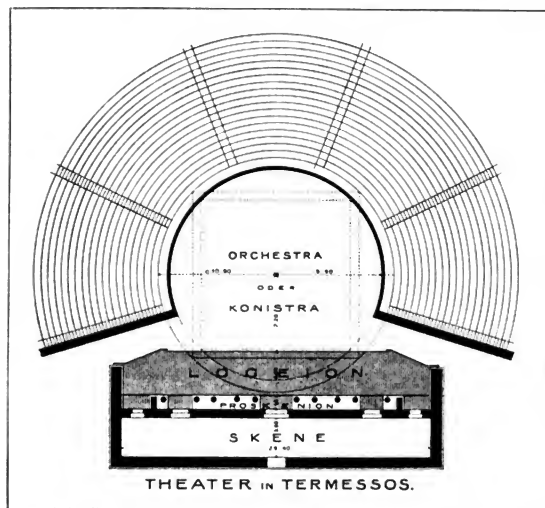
Grundriss des Theaters zu Termessos. (S. 244.)
